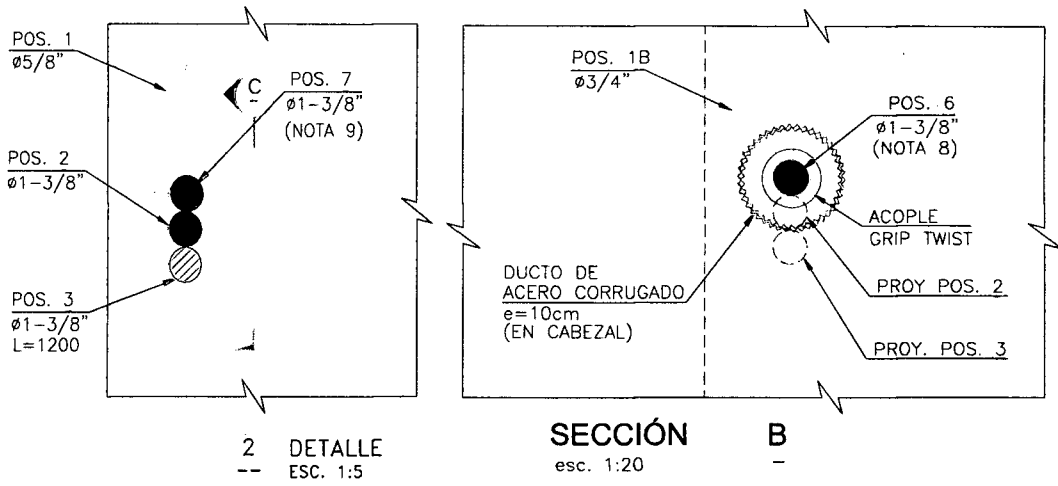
Detalle de la proyección del acero y ducto para empalme.
